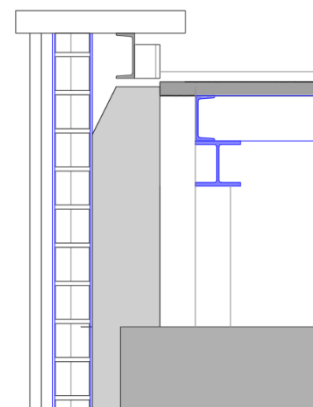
Detalle antepecho de planta de cubierta edificio de acceso a la ETSA Autor: Estudio VVV
